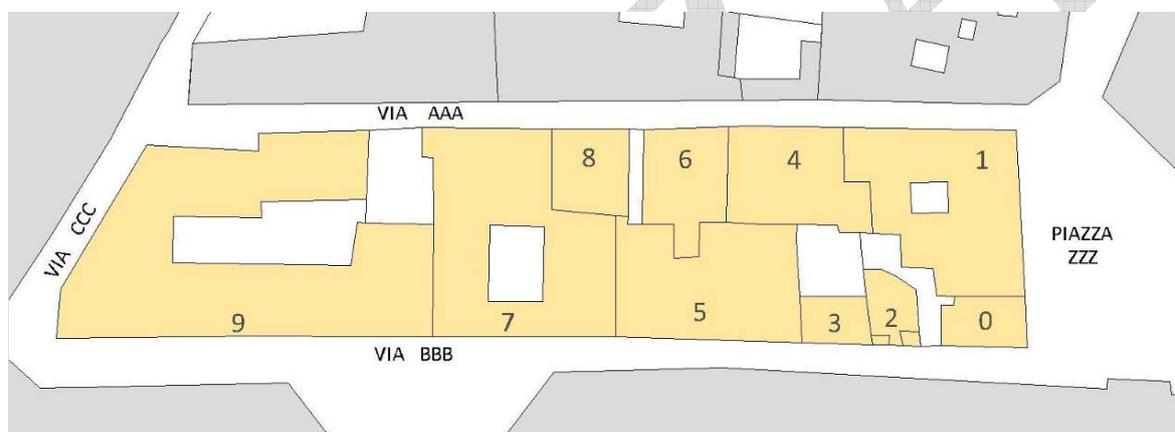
Stralcio planimetrico dell'aggregato in oggetto
